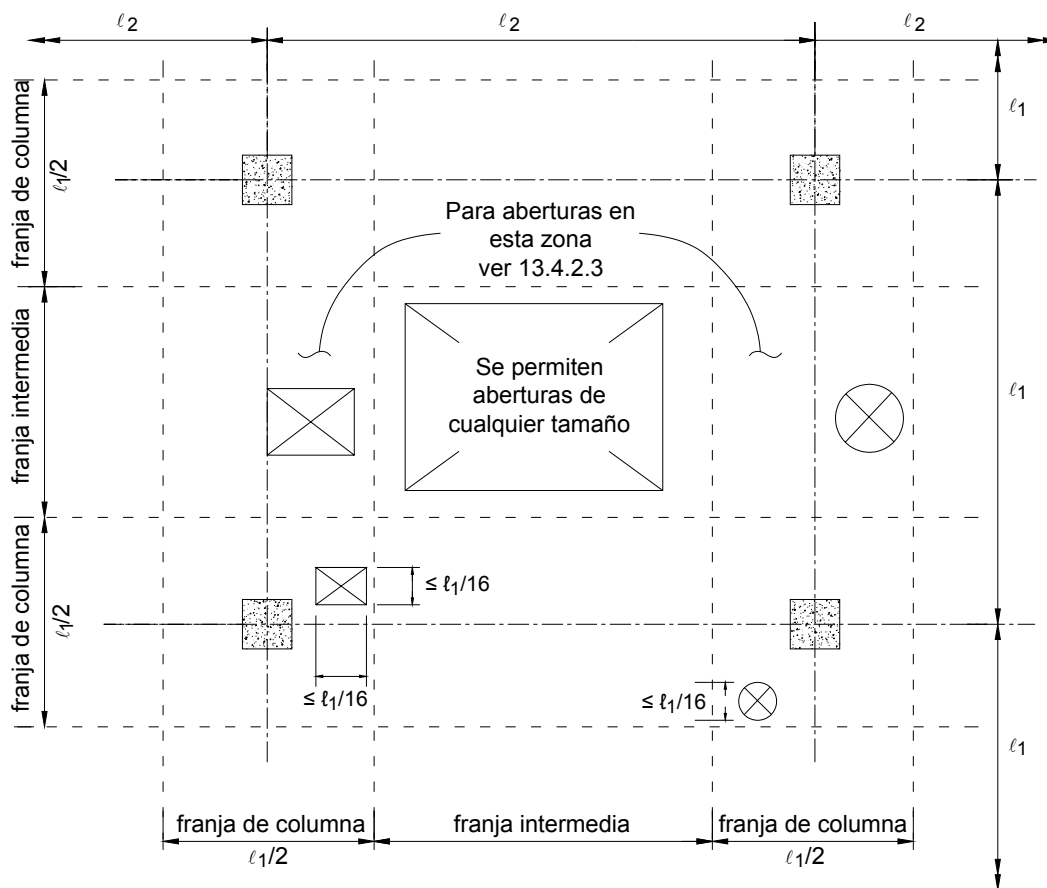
Aberturas permitidas en los sistemas de losas sin vigas para  $\ell_2 > \ell_1$
